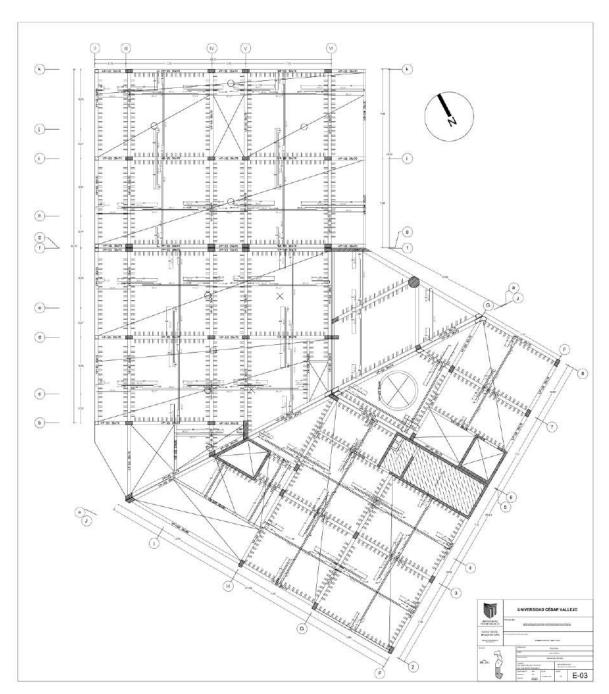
Aligerado - Segundo piso sector B - ESTRUCTURAS
